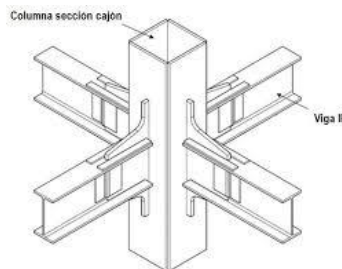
Conexión viga-columna (Tapia,2020)
